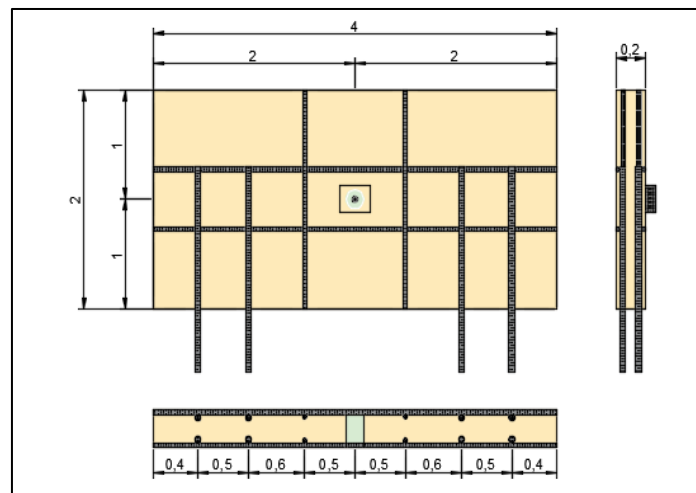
Esquema panel prefabricado Modelo 3. Fuente: Propia
